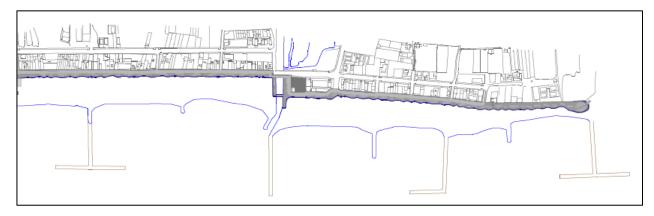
Planta alternativa 1 de la playa de la Alcudia. Fuente: Propia.
